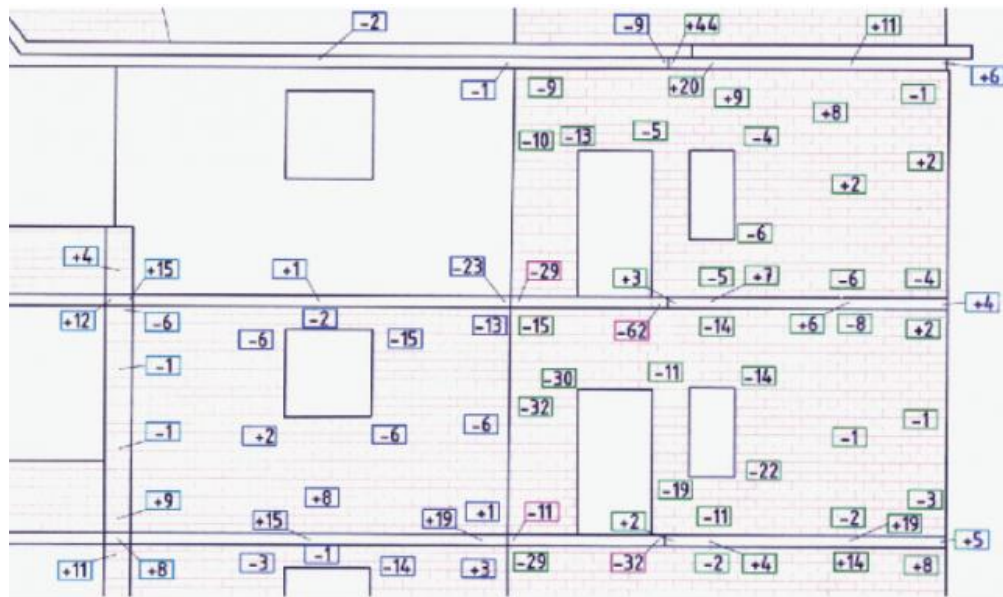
Фрагмент розгорнення фасаду з відхиленнями від вертикалі цегляної кладки та бортів перекриттів
